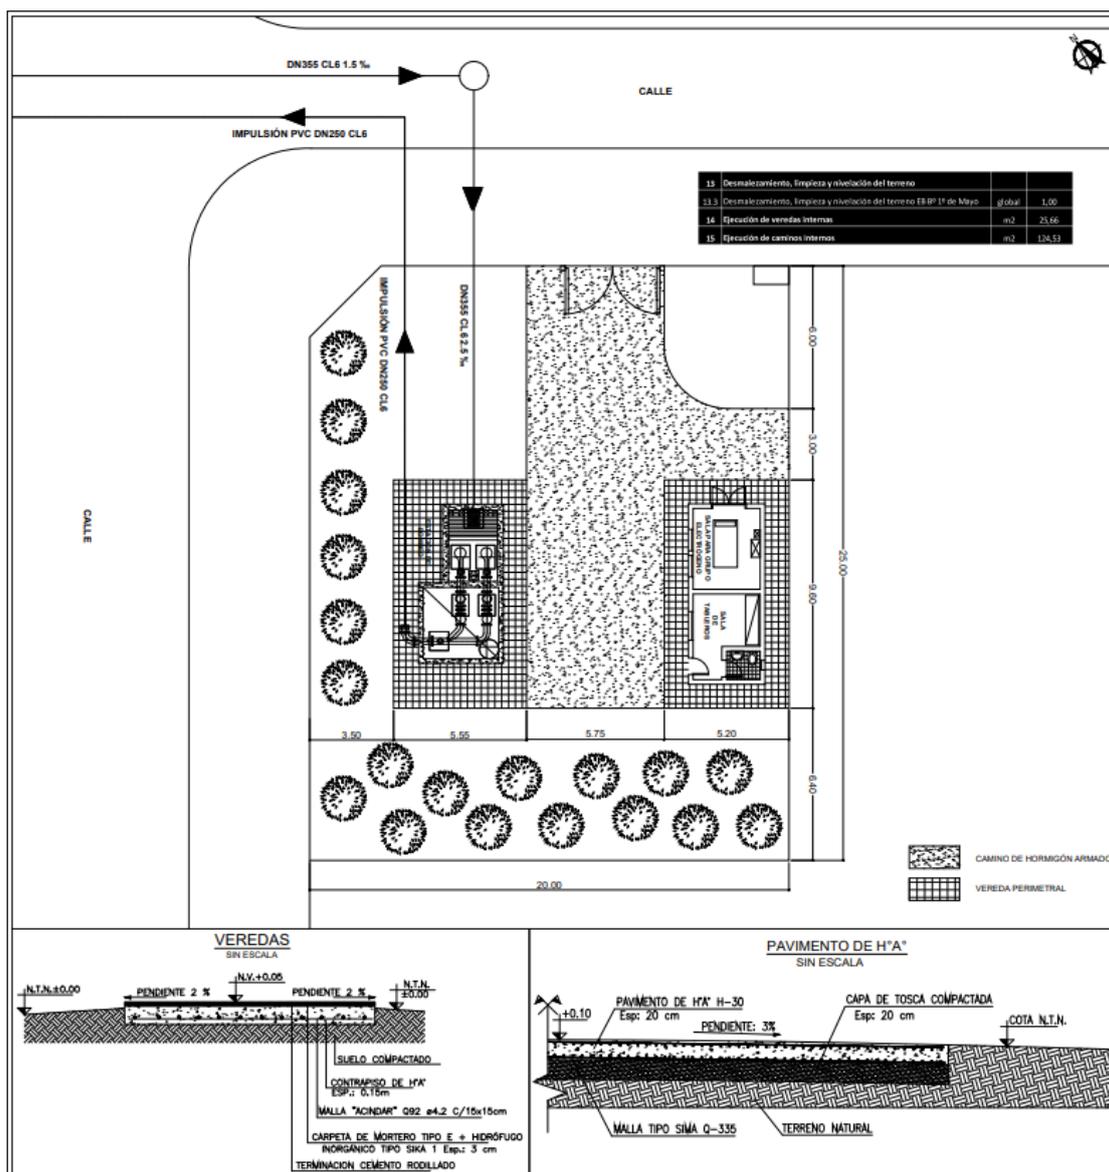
Plano de pavimento y veredas internas a ejecutar en Estación de bombeo 3, barrio 1º de Mayo (EEB 3).
